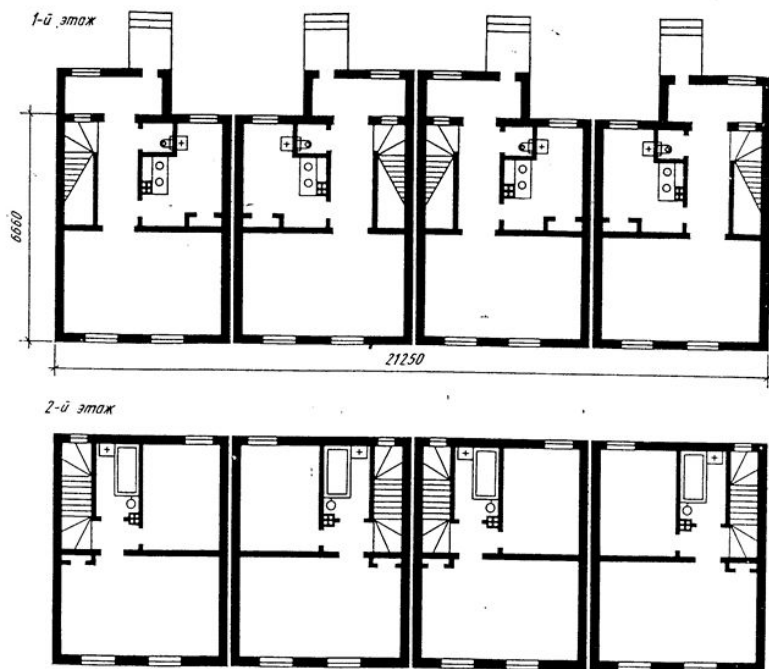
План жилого дома из объемных блоков размером на квартиру
